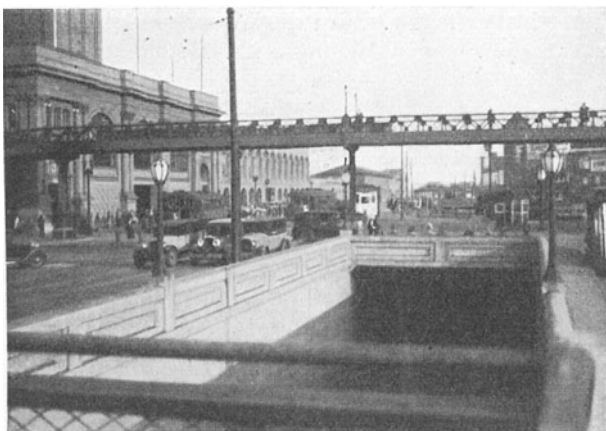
Platz vor dem Fährgebäude in San Franzisko (V. St. A.). Führung des Verkehrs in 3 Stockwerken.
